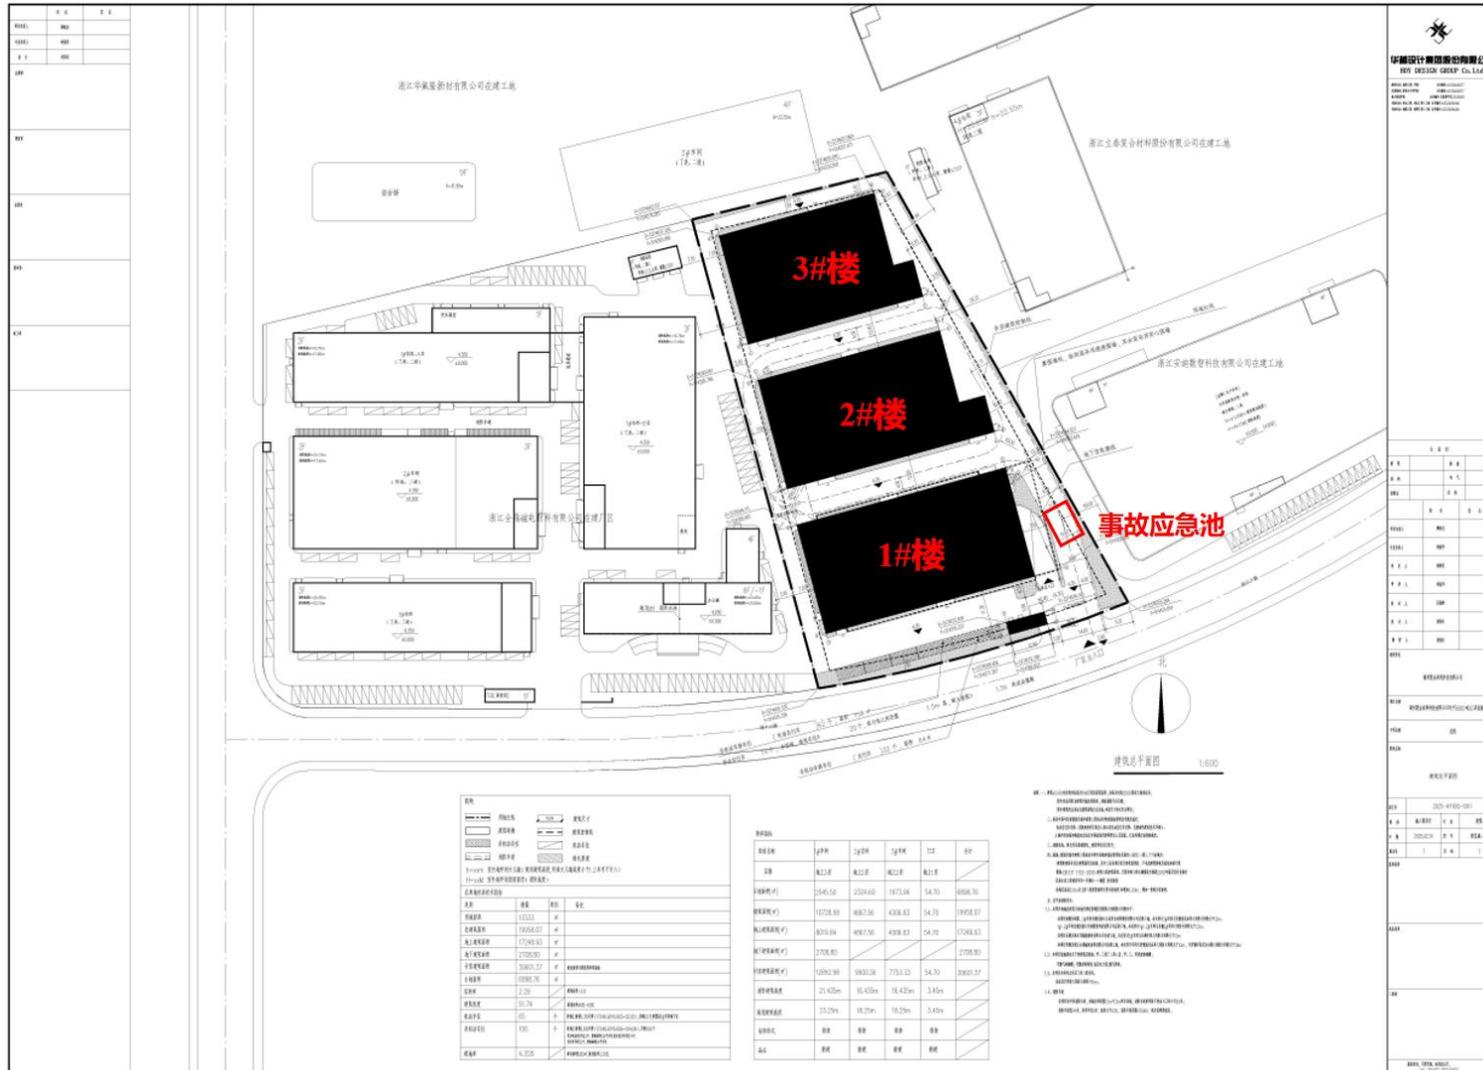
建设项目总平面布置图（黑色虚线内为本项目）
